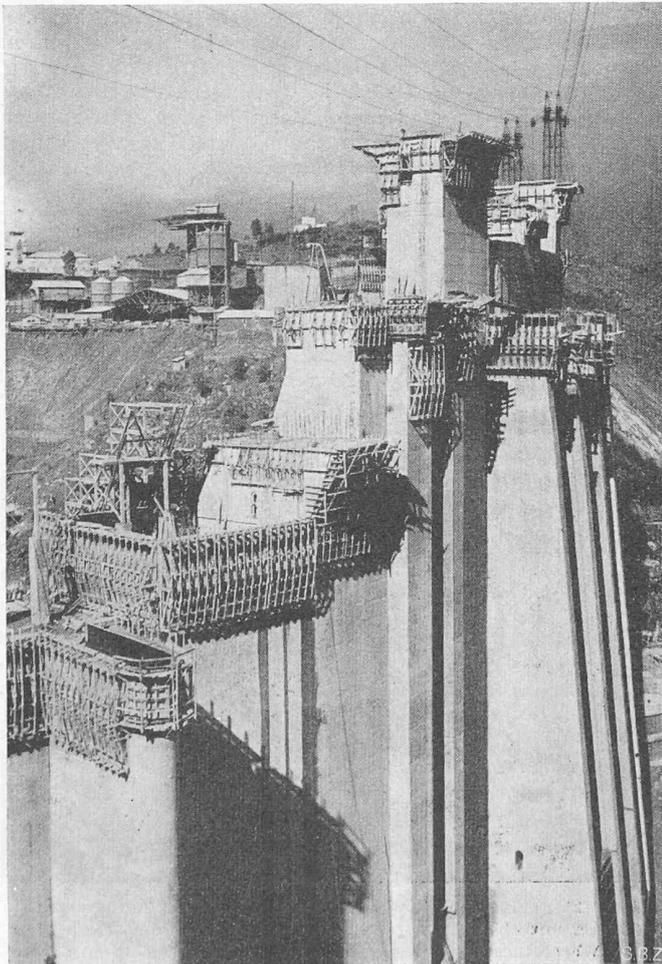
zeigt das Aussehen der Betonoberflächen. Rechts die Rechen- und Schützenbahnen; links Ueberlauf, dessen Kante 18 m unter der Krone liegen wird. Aufbau des Eisenbetons in 3 m-Blöcken
